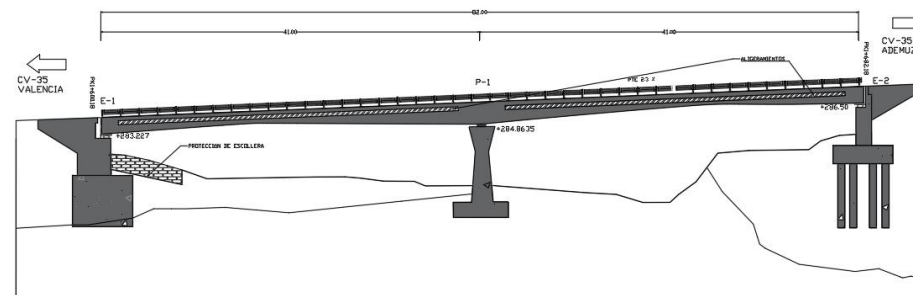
Vista en alzado de la solución adoptada. Fuente: CAD de elaboración propia.
